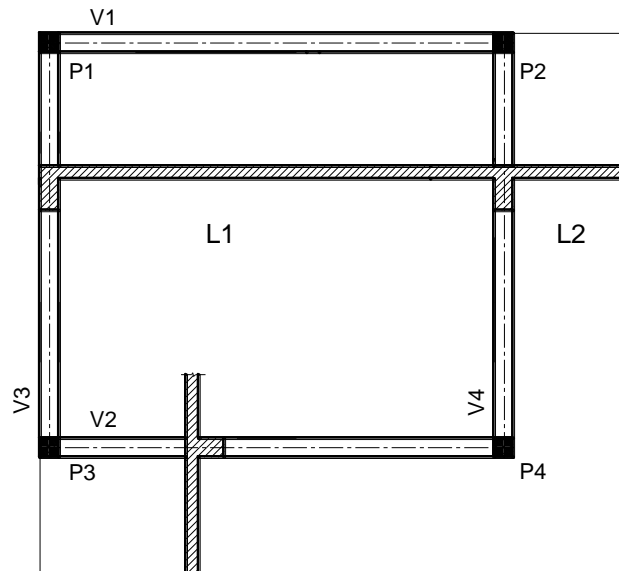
Lajes maciças e laje em balanço (L2).
